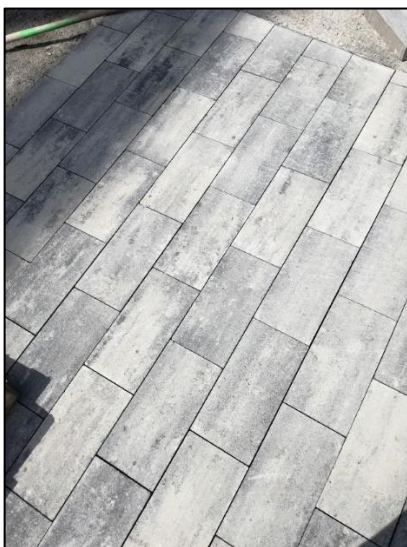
Losa de hormigón usada como pavimento para la acera. Fuente: Elaboración propia.
